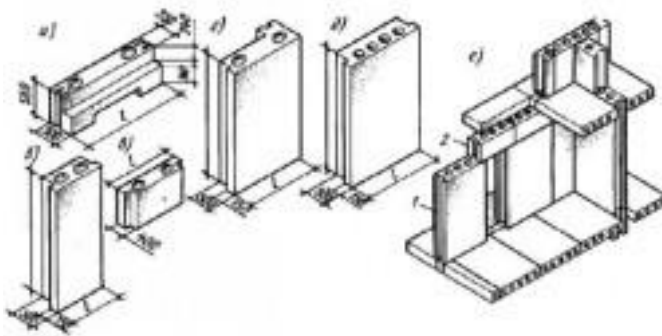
Типы крупных блоков стен жилых зданий: а — блок наружной стены перемычечный, б — то же, простеночный, в — то же, подоконный, г — то же, угловой, д — то же, с круглыми пустотами, е — блоки внутренних стен, 1 — вертикальный блок, 2 — горизонтальный
